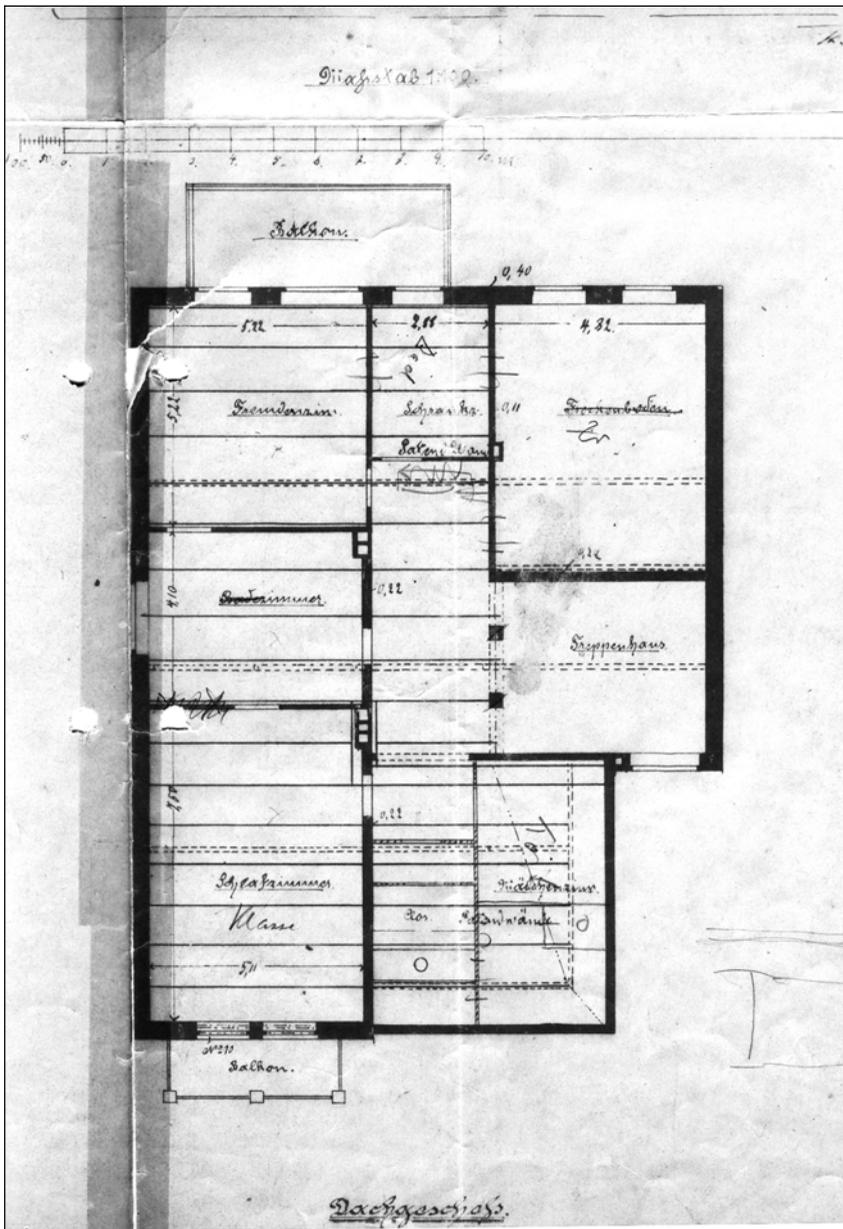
Dachgeschossplan von 1899 mit ursprünglichen Raumbezeichnungen. Weitere Eintragungen wie Abb. 5.; aus dem Baugesuch (Bauaktenarchiv der Stadt Itzehoe)
